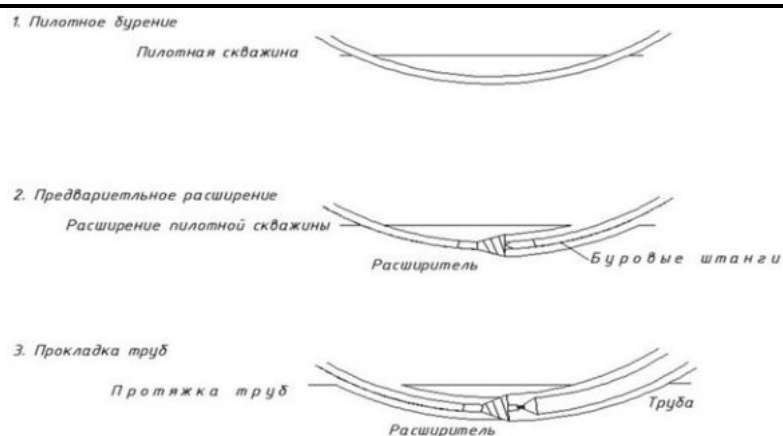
Этапы прокладки трубопровода
